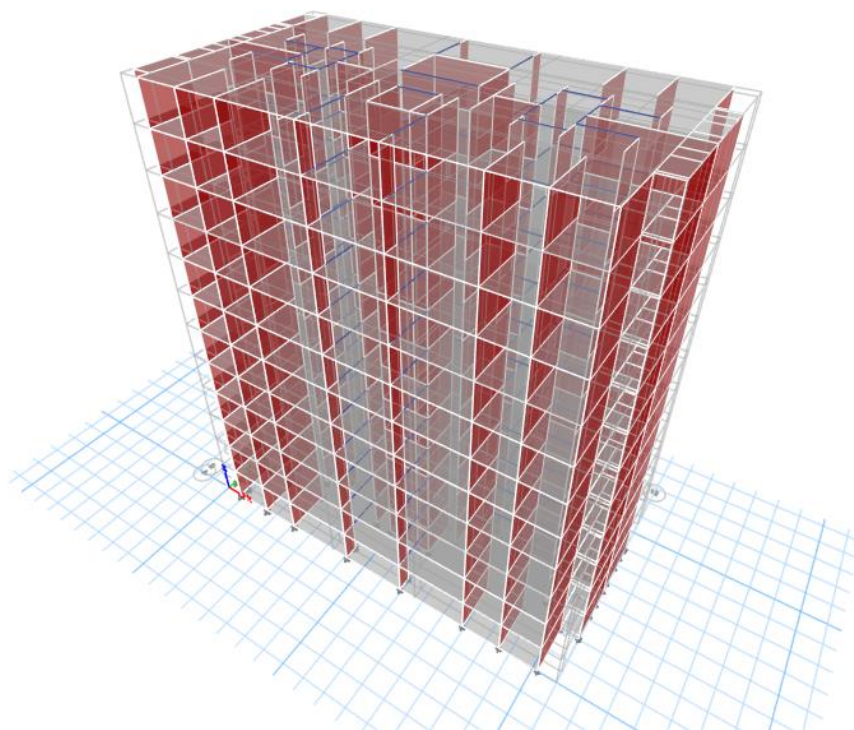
Modelo estructural del edificio visto en alzado. Fuente: Elaboración propia.
